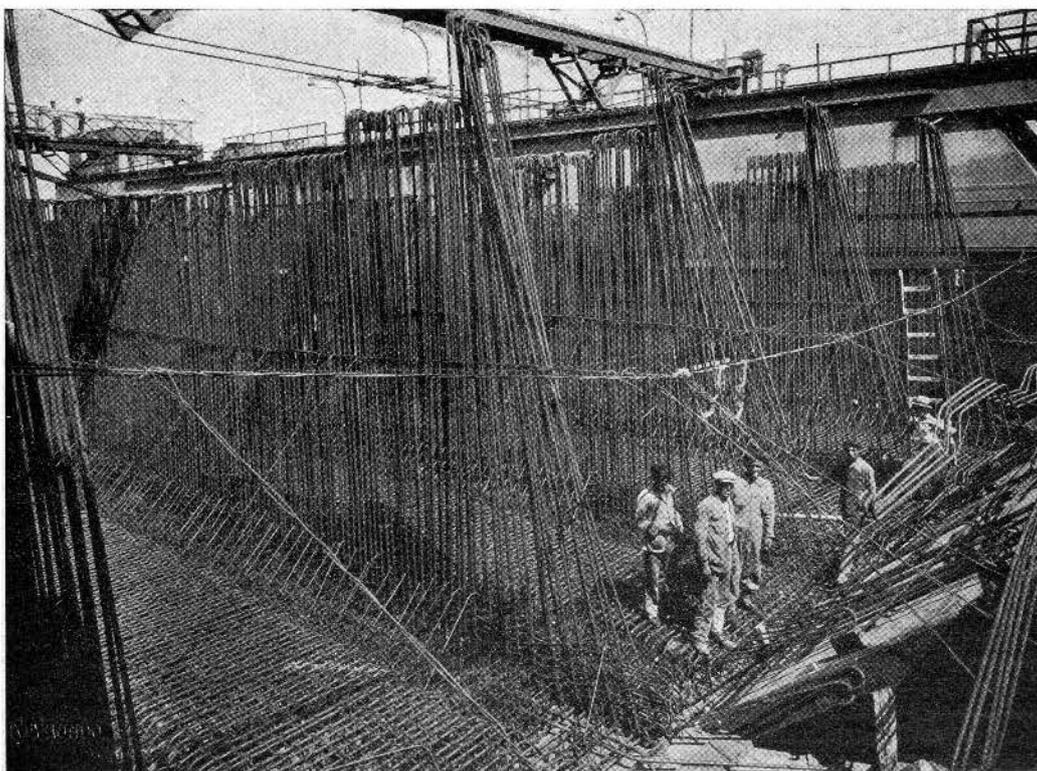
Armaduras de los mamparos del cajón, que son vigas cuadernas de la solera del dique, para su trabajo definitivo
